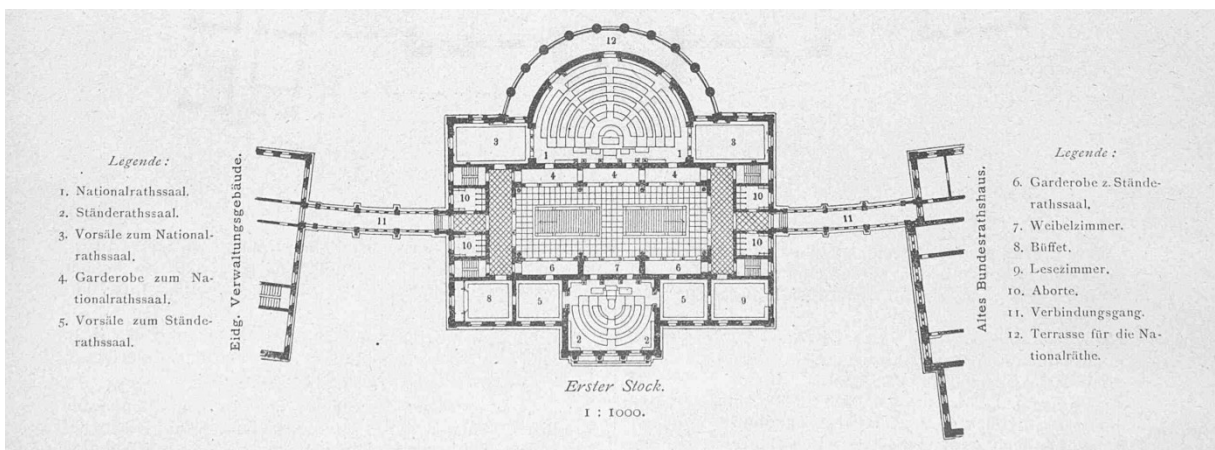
Grundriss erster Stock, Bluntschli.
